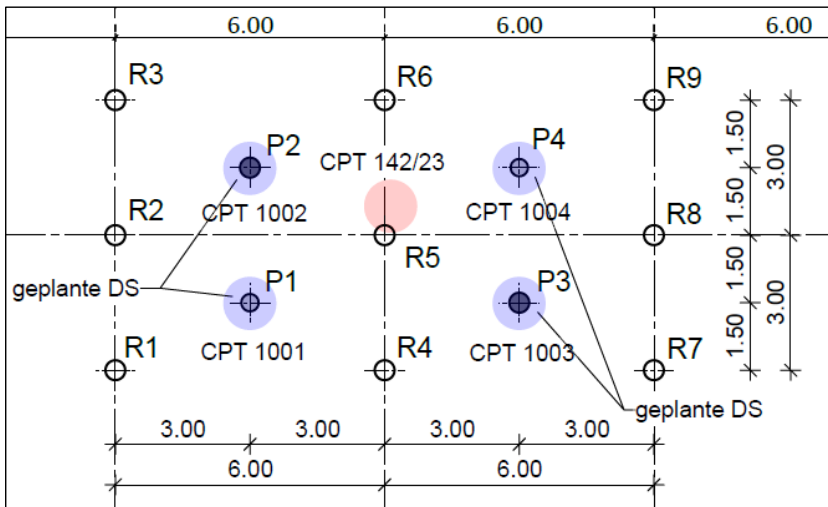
Lageplan Drucksondierungen Testfeld 2 - Heide 1
